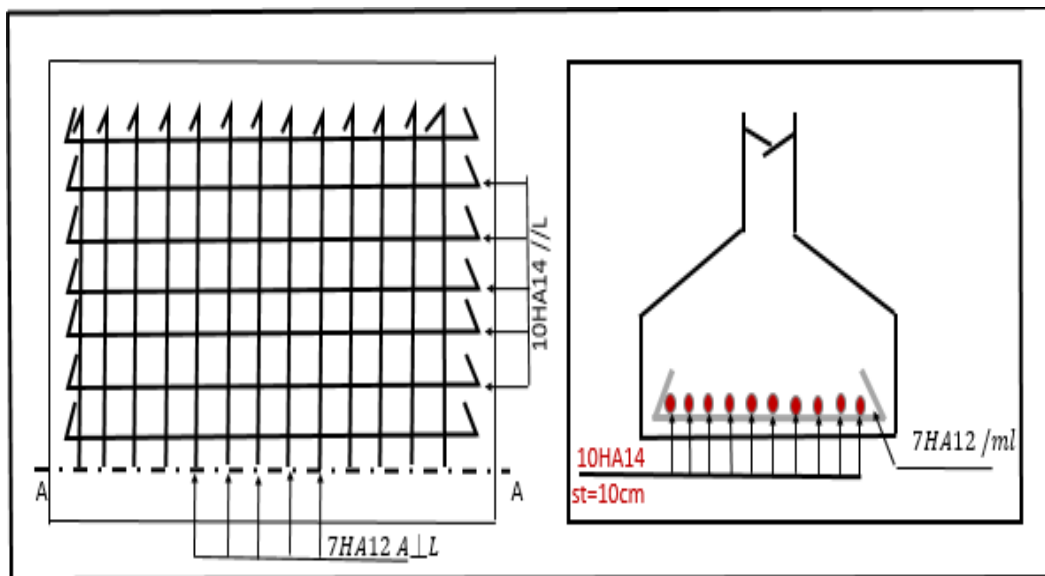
schéma de ferrailage de la semelle filante sous poteau
